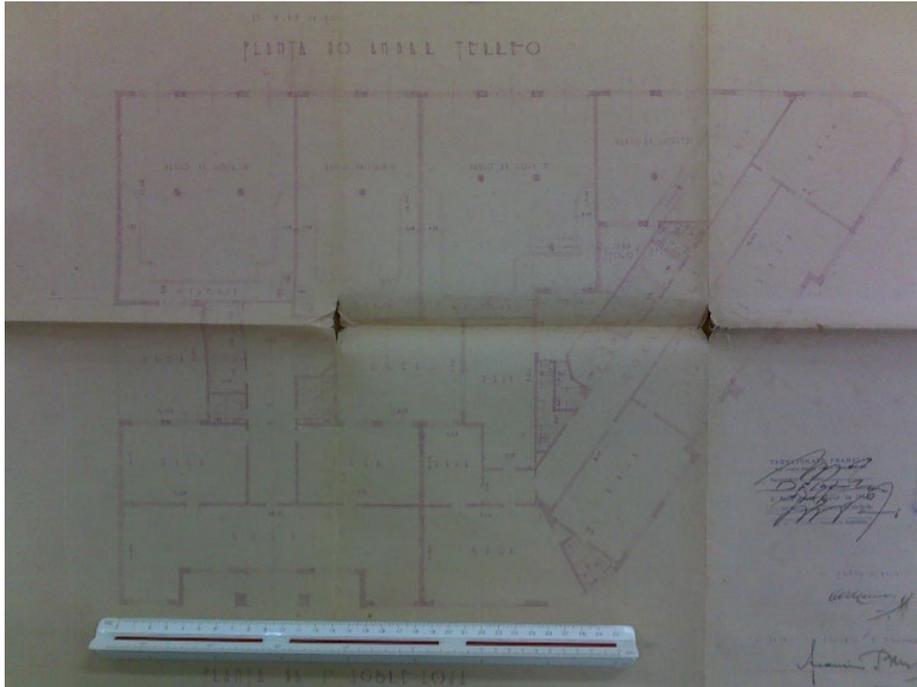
Planta térreo, projeto original. Fonte: COHAB
